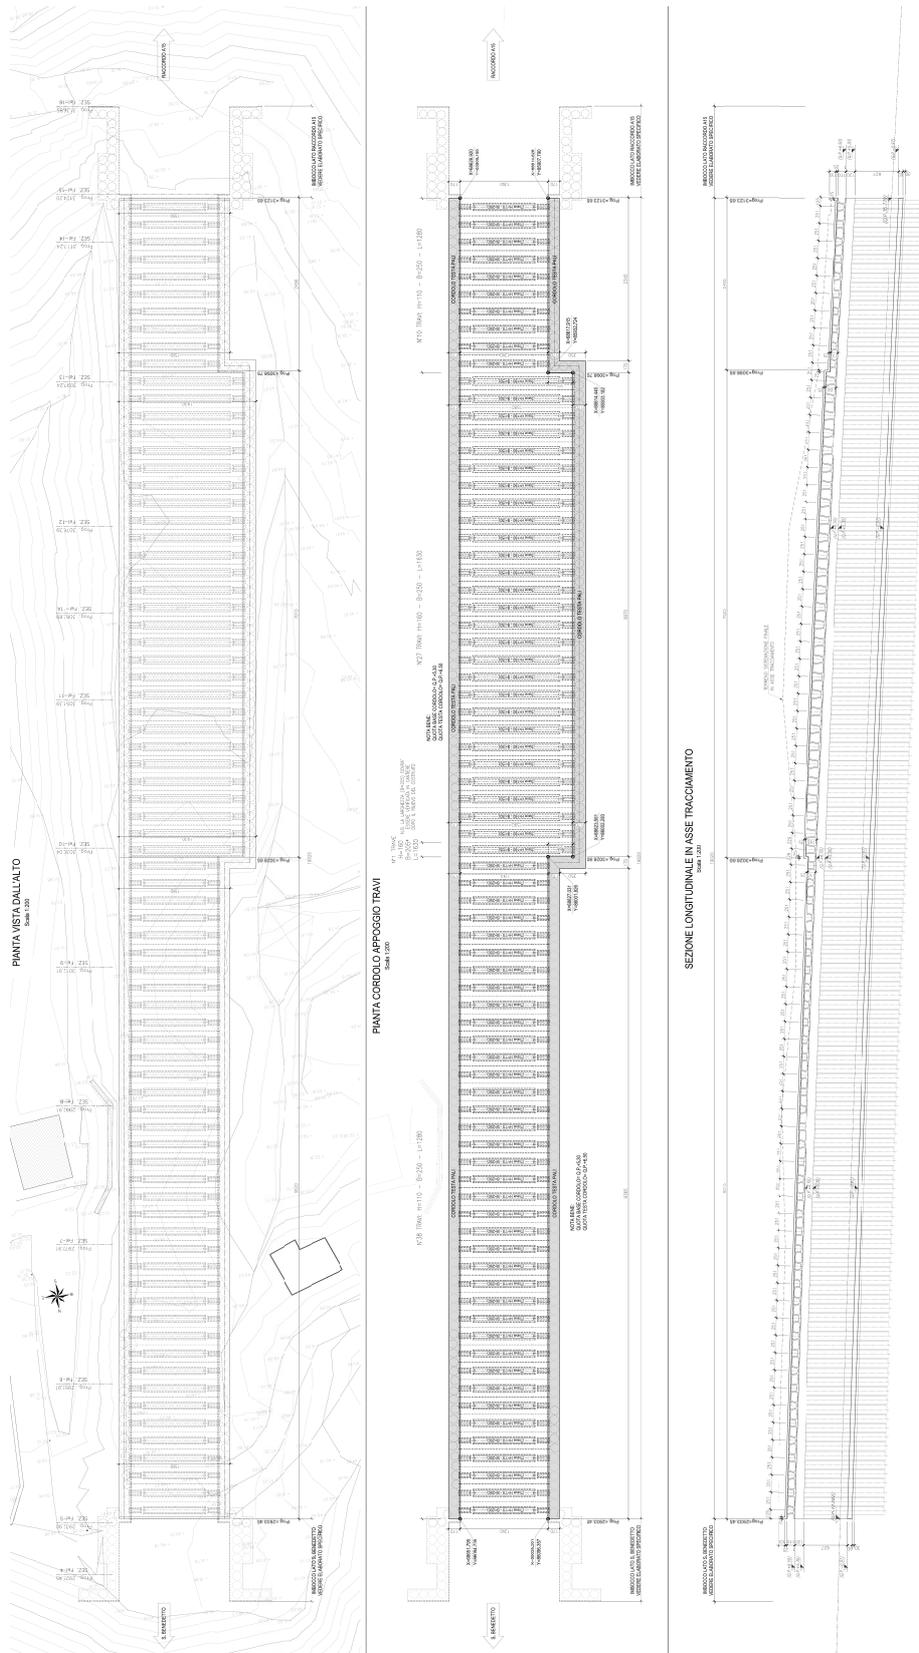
Galleria artificiale Felettino II – Planimetria e profilo
